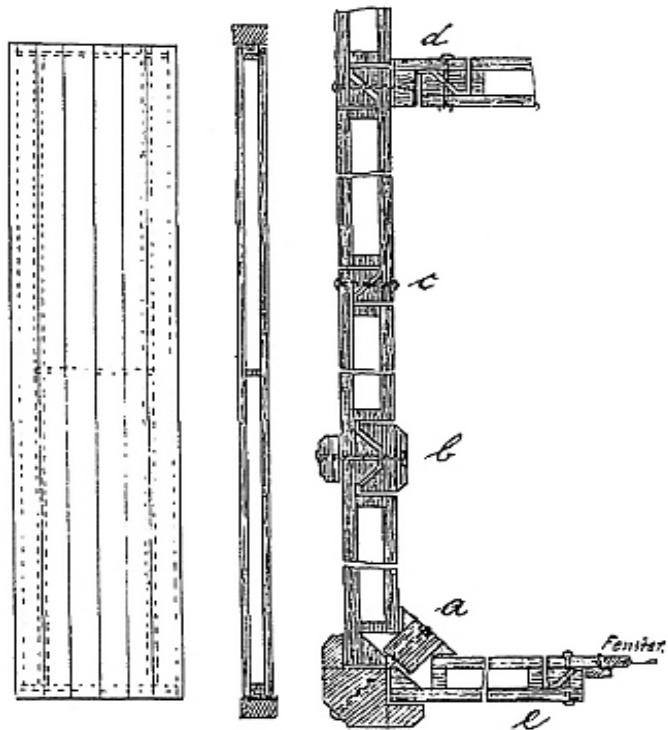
Bauweise für demontable Bauten aus [83], S.115
